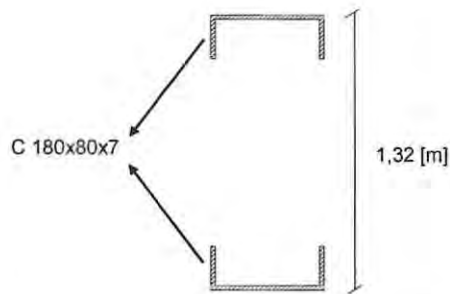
Corte 1-1 sección transversal viga fachada.
